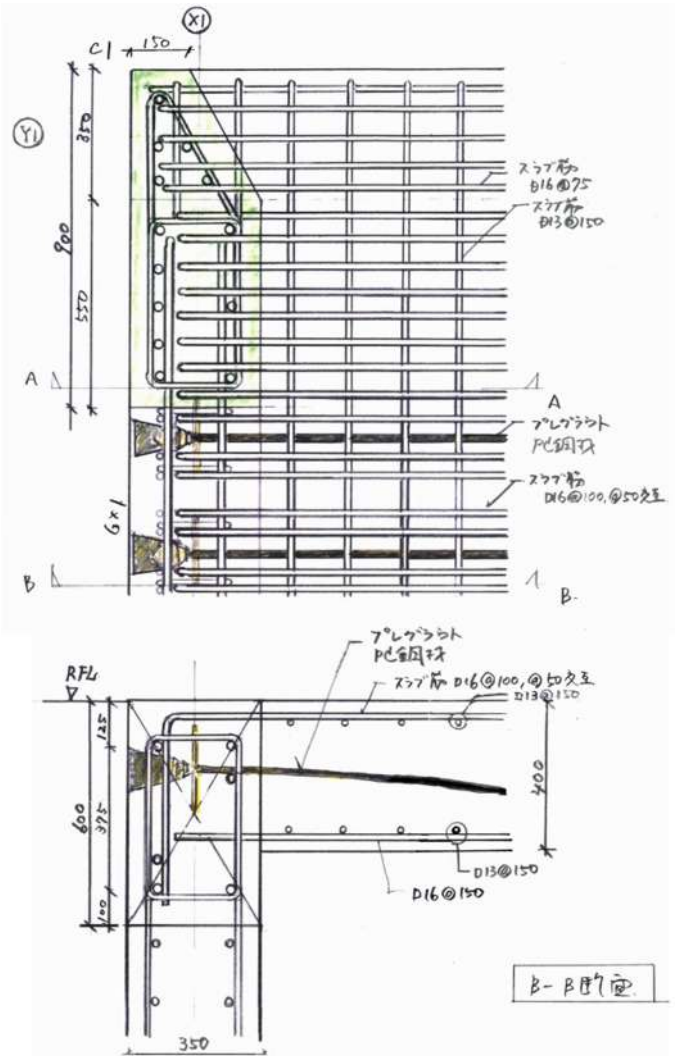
部材断面決定のスケッチ(上:平面、下:断面)
